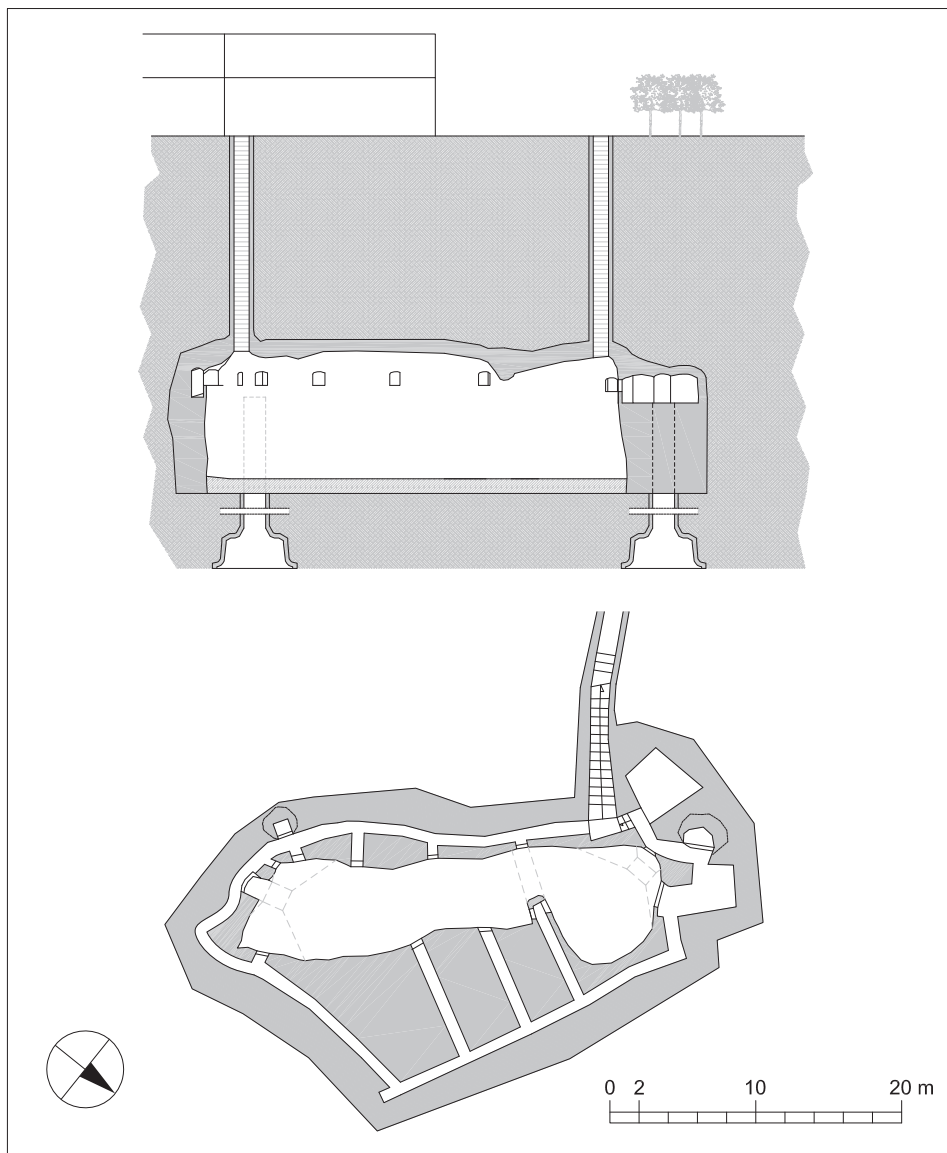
Gallo, cantina C13. Pianta e sezione longitudinale.
